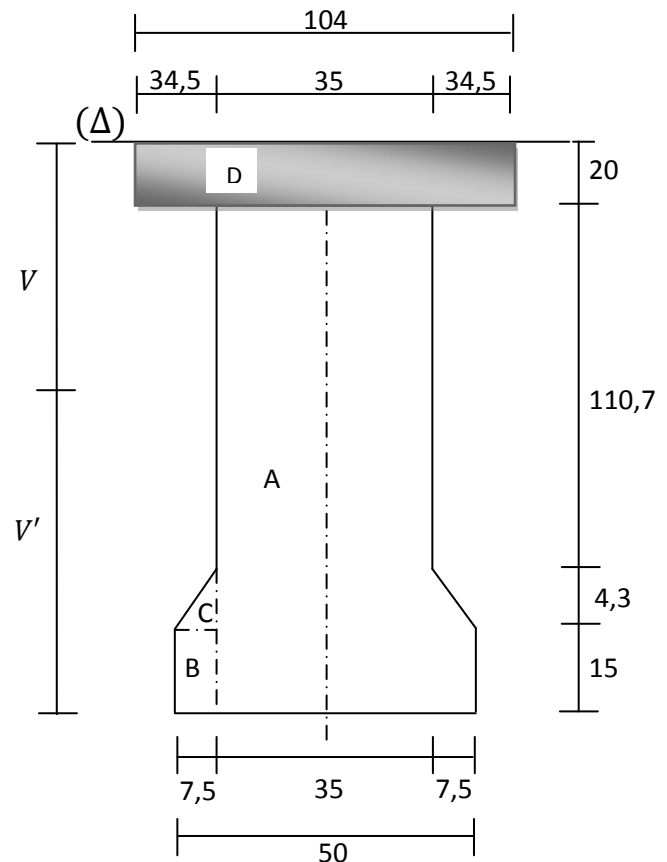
Poutre intermédiaire section d'about avec hourdis.
